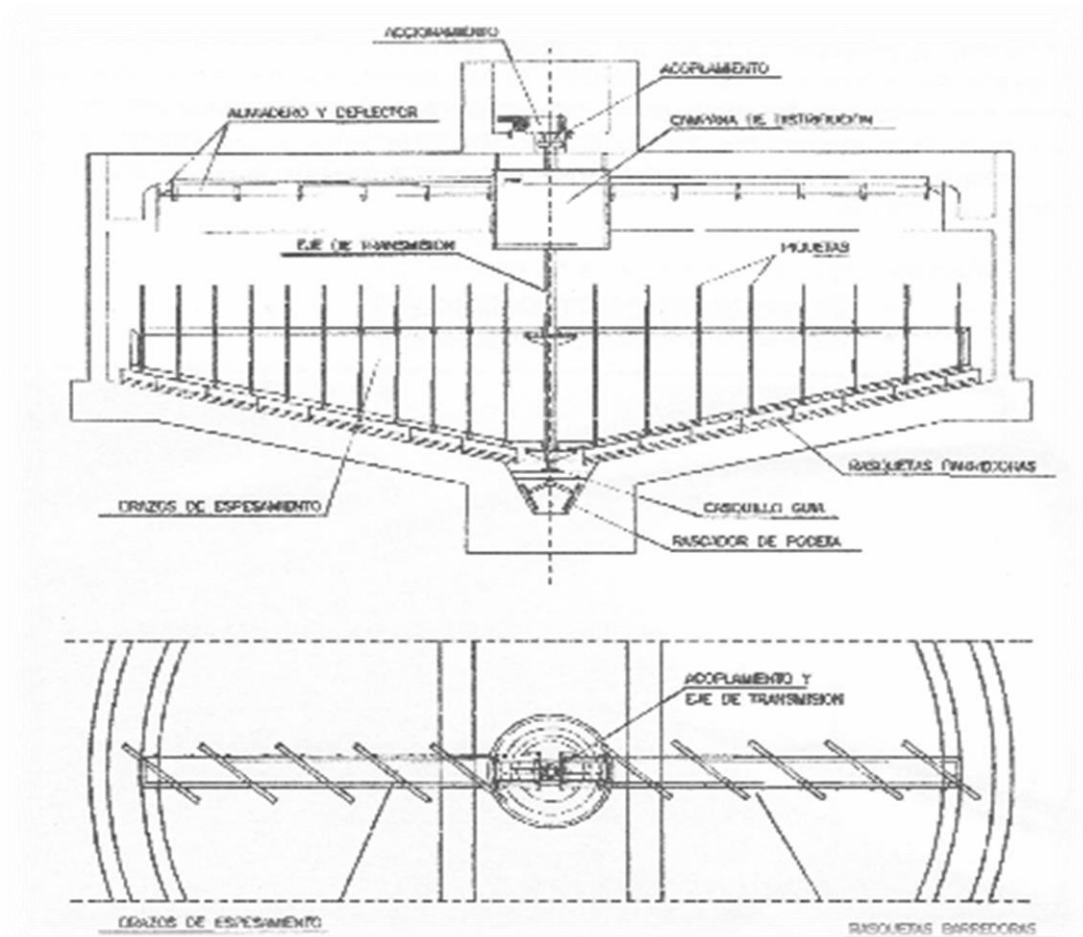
Imagen que muestra planta y alzado del espesador por flotación
